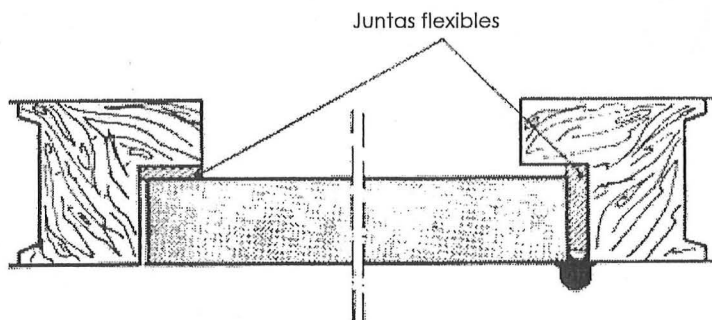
Juntas flexibles en el fondo del rebajo de una puerta
